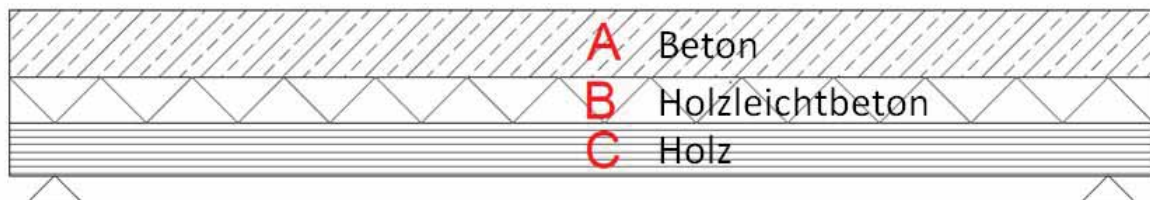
Sandwichaufbau: Holz-Holzleichtbeton-Verbund (HHV), nach [25]
